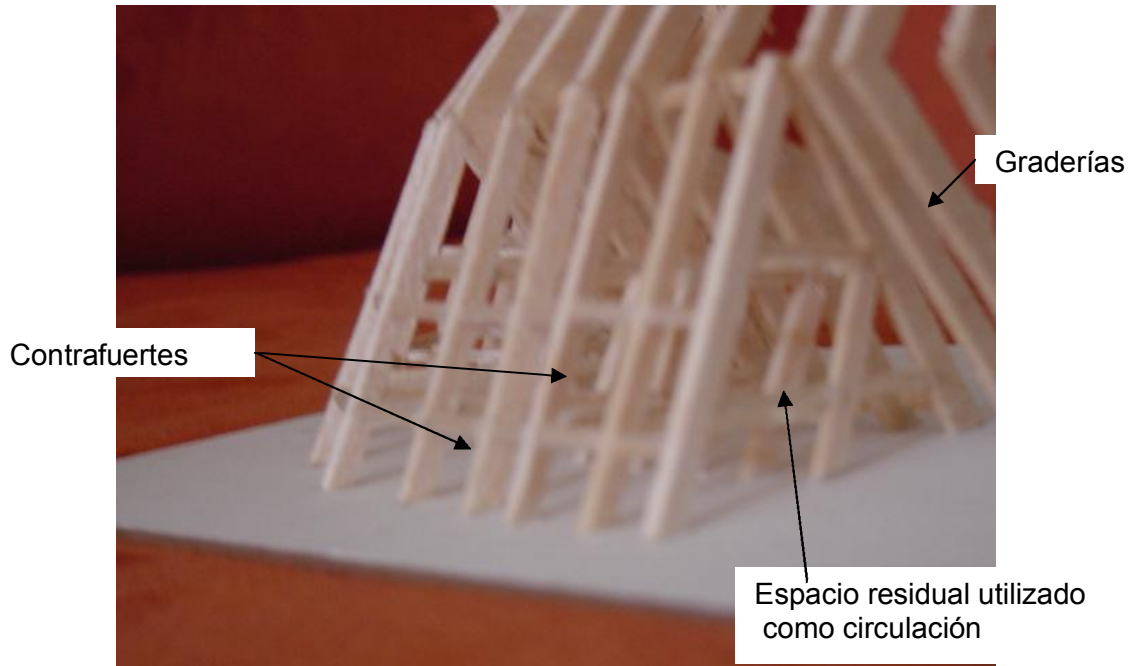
Estructura del estadio vista desde el exterior
